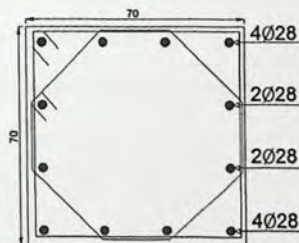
Sección columnas estructura de estudio. $\rho = 1.5\%$
